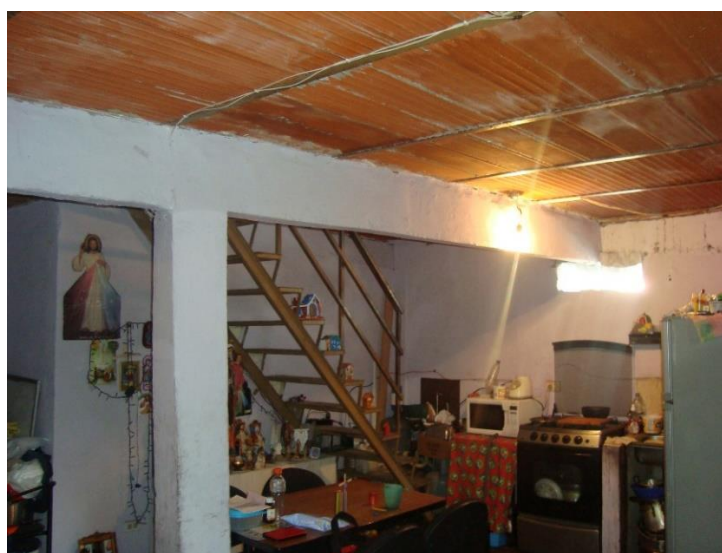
Pórtico en una sola dirección con viga en volado. Vivienda #1. Chapellín, Caracas. (Fuente Propia).
